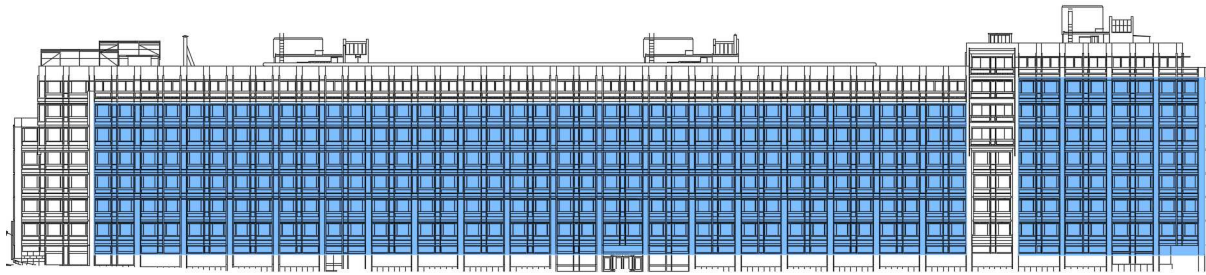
Área inspecionada com recurso a andaimes. Fachada poente
